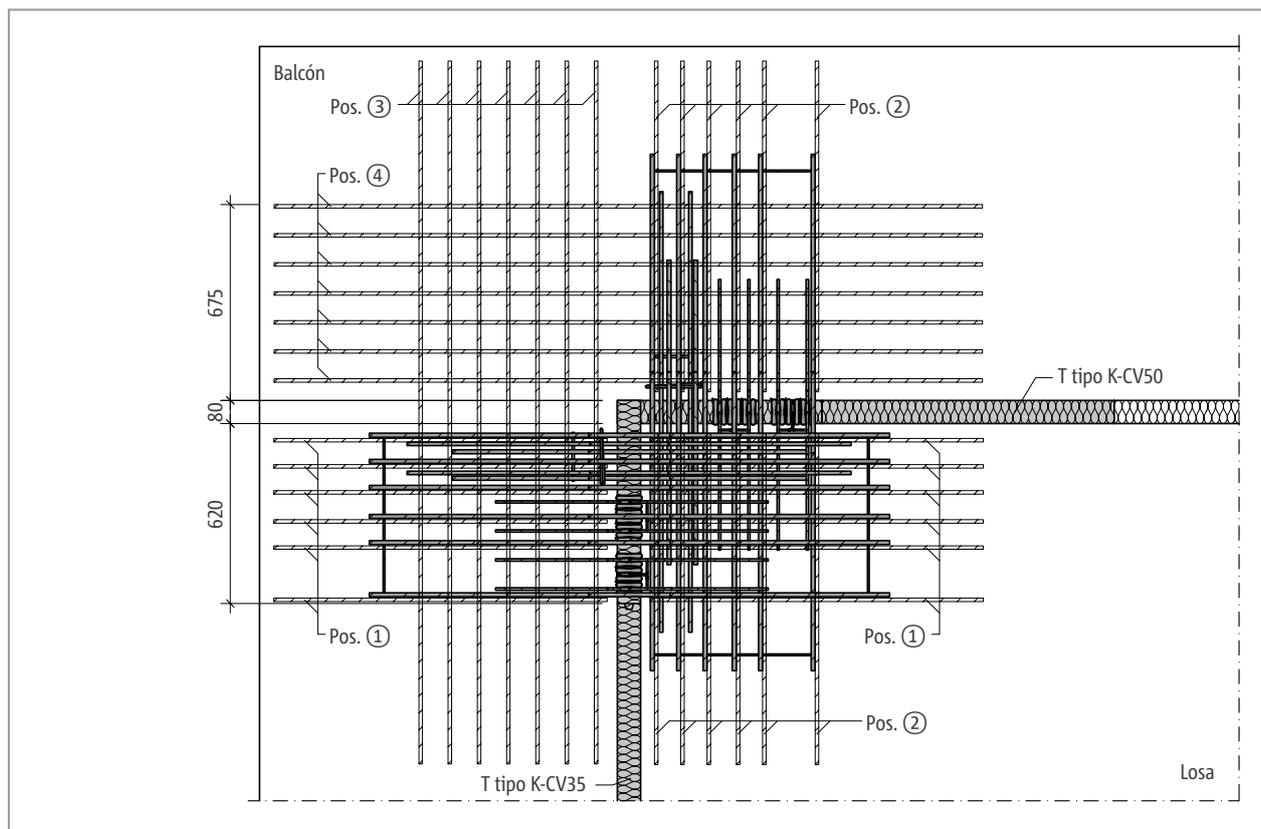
Schöck Isokorb® T tipo C-M3: Armadura in situ (posición superior)
